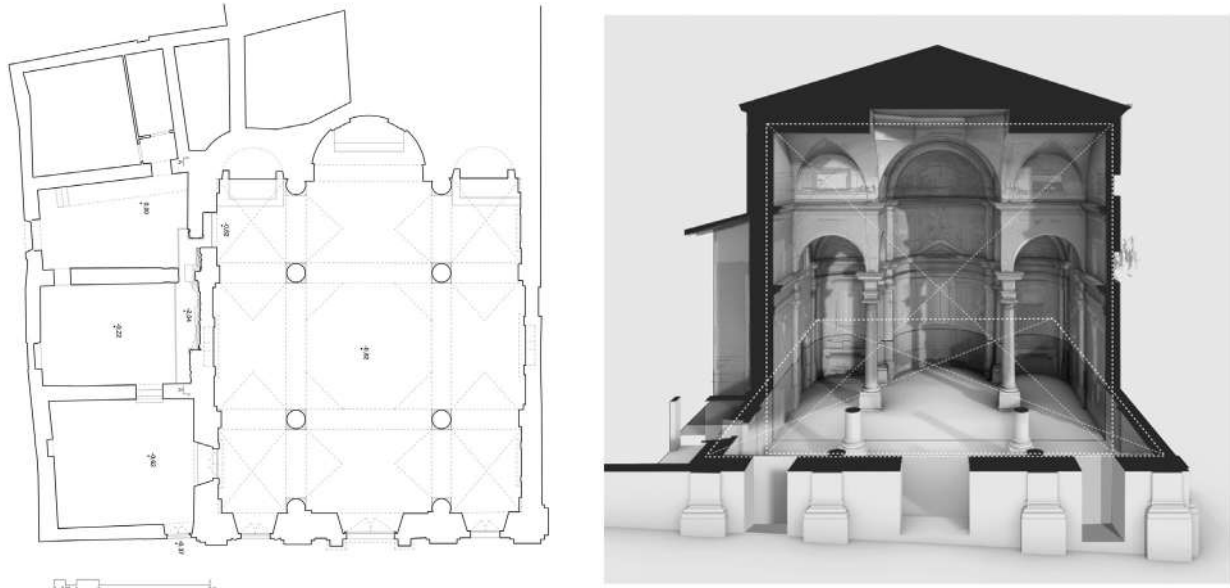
Palermo, Chiesa di S. Andrea Apostolo: pianta e spaccato prospettico dell'interno, disegno interpretativo (rilievo e elaborazione grafica di Laura Barrale)
